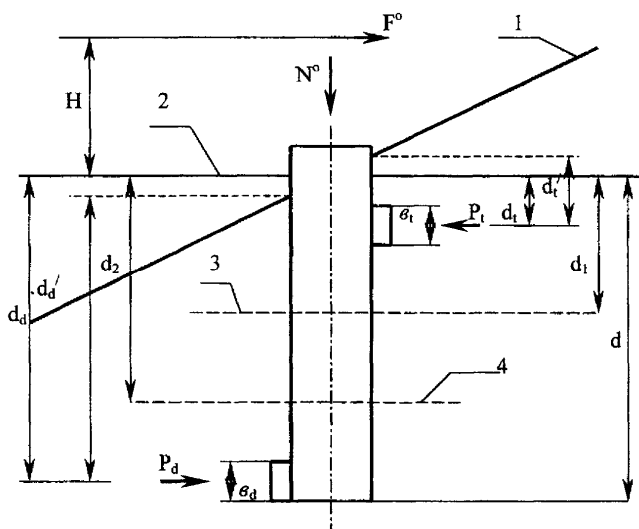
Расчетная схема фундамента с лежнями: 1 - фактическая поверхность грунта; 2 - расчетная поверхность грунта; 3 - граница верхнего и среднего слоев грунта; 4 - граница среднего и нижнего слоев грунта.
